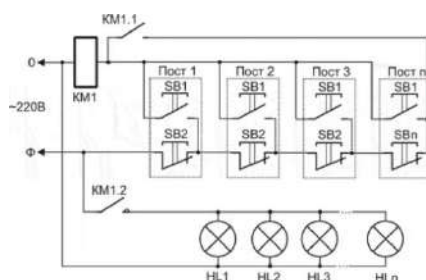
Схема одновременного включения и выключения освещения на лестничных площадках подъезда жилого пятиэтажного здания
